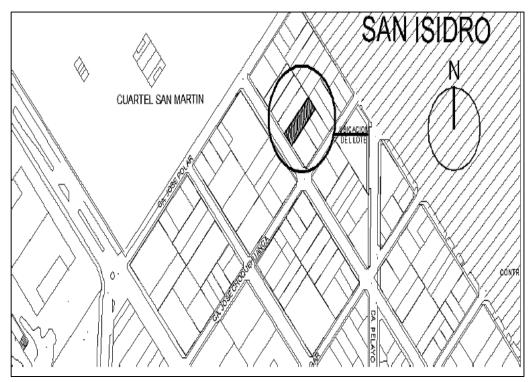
Plano de localización de una vivienda en San Isidro. Fuente: Autoría propia.
